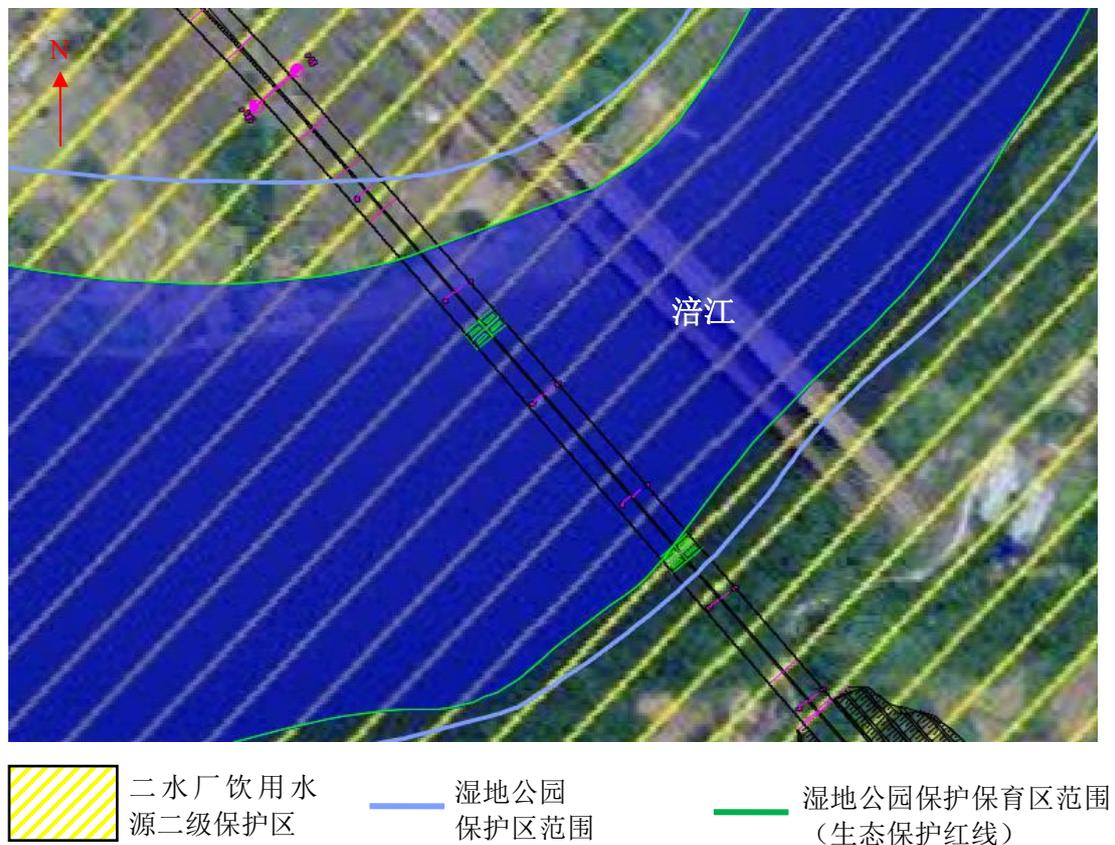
涪江五桥跨越涪江桥型平面图
